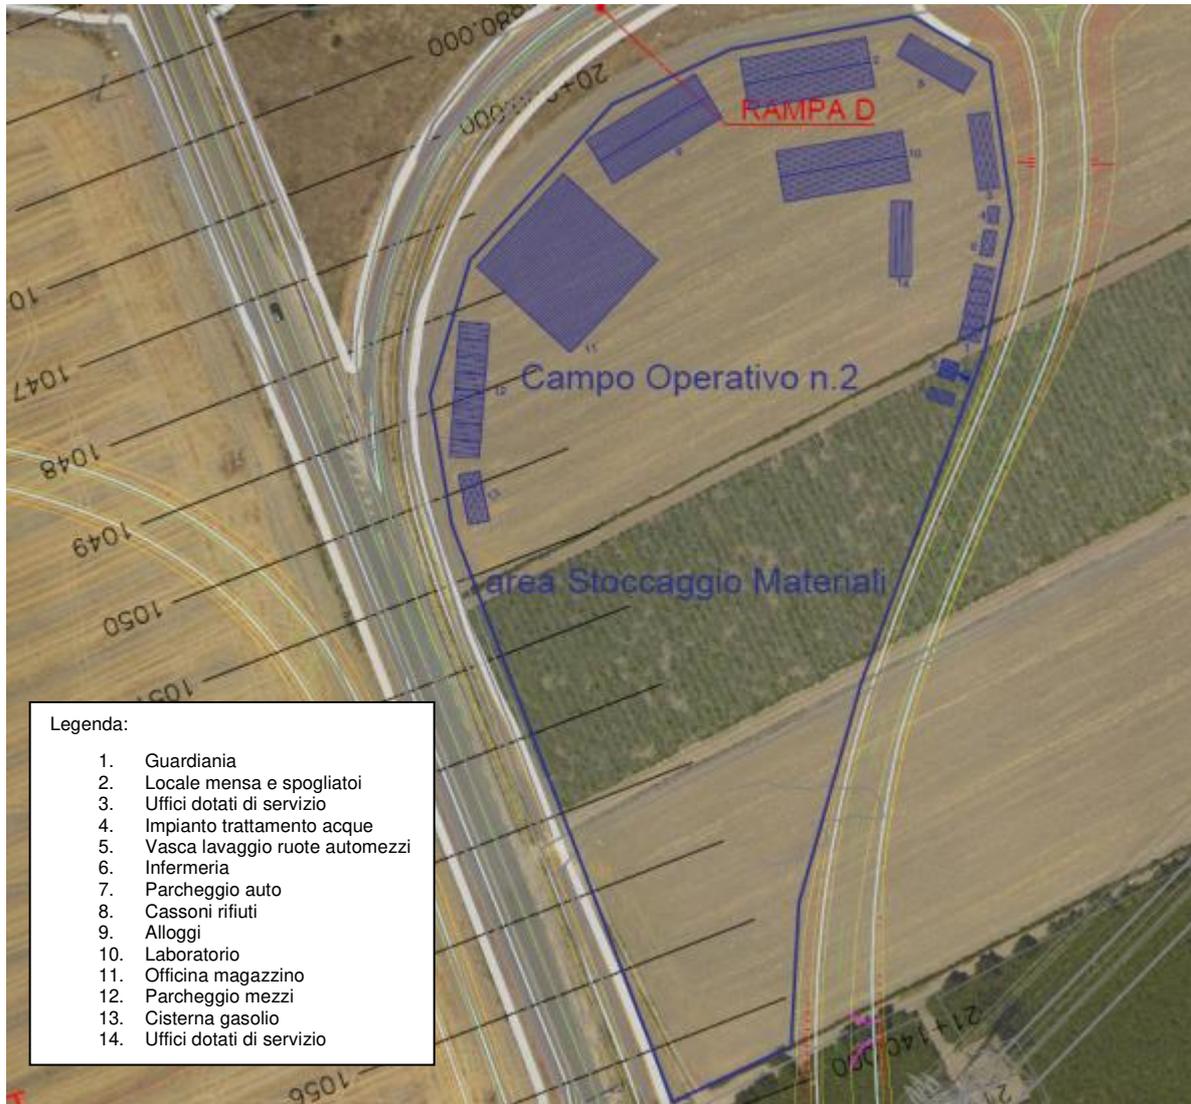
Ipotesi layout cantiere operativo CO_2
